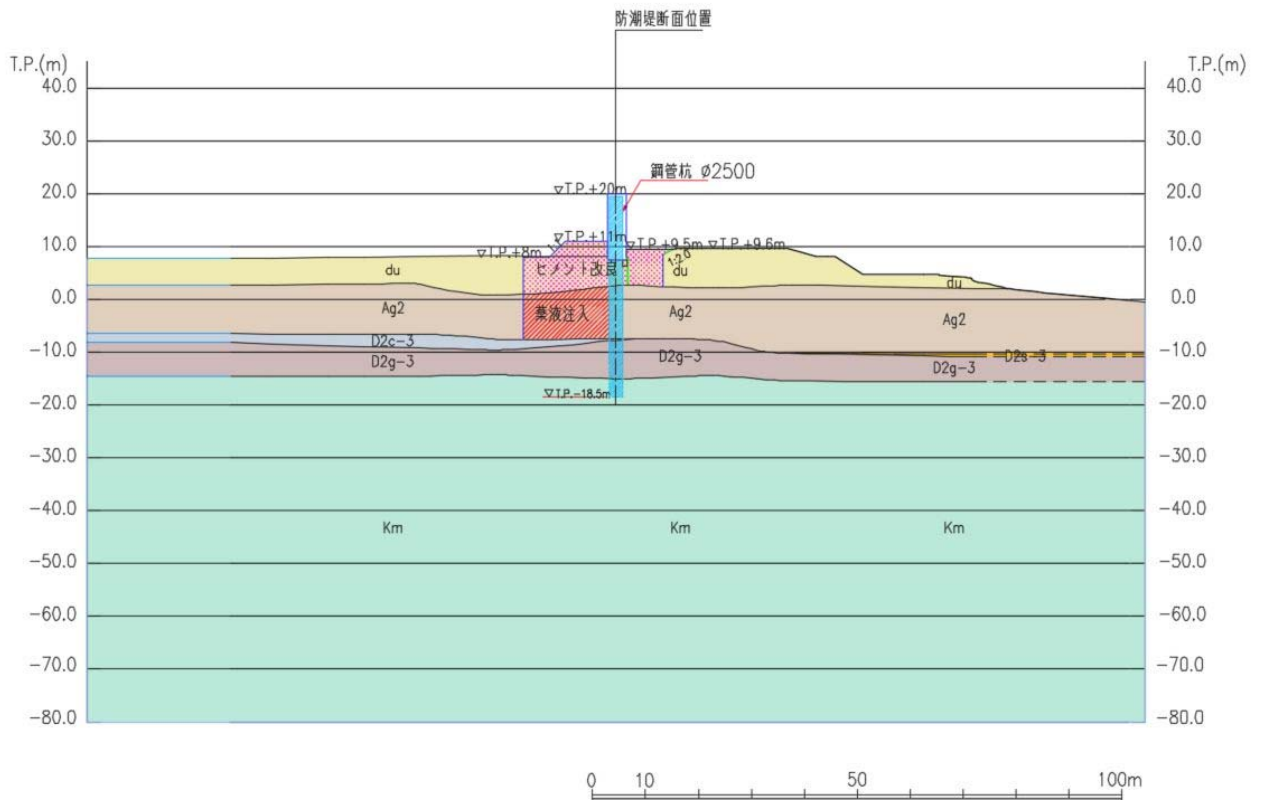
11. 5-21 (2) 鋼管杭鉄筋コンクリート防潮壁 断面図 (断面②)
